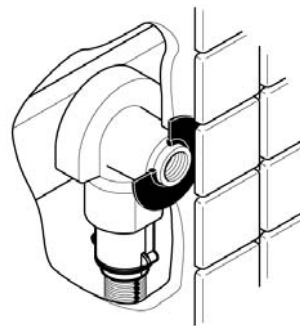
Impermeabilización de salpicaduras 240.243.00.1 /240.244.00.1 para construcciones en madera o ligeras
